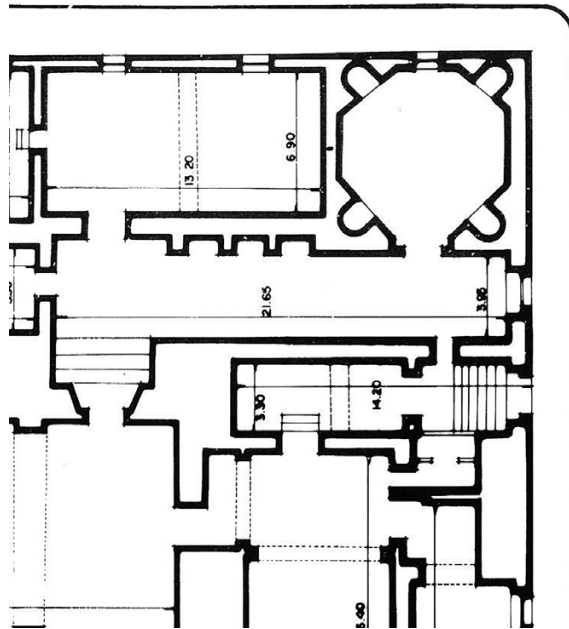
Planta del Ochovo de la catedral de Puebla.
